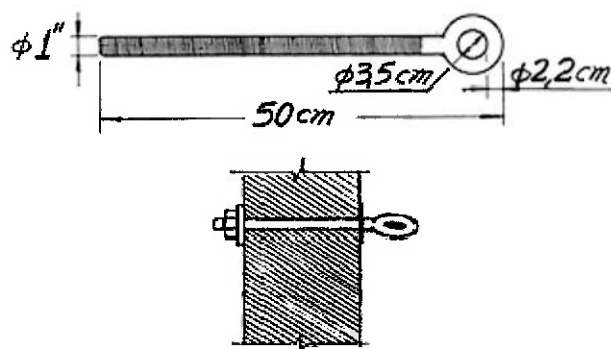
Pontos de Ancoragem (fonte: o TST Brinks)
